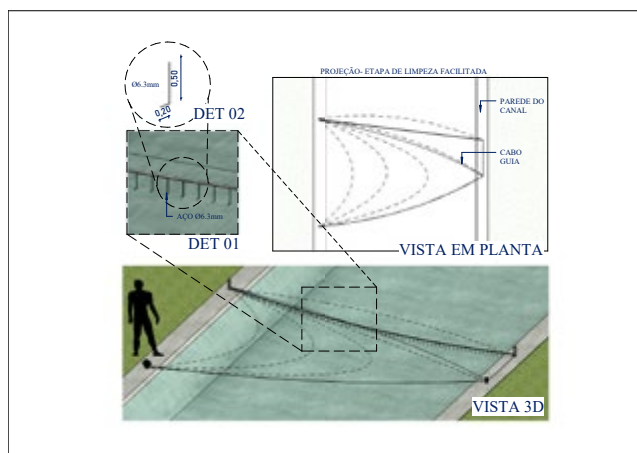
Vista, Projeções e Detalhamento da Ecobarreira.
